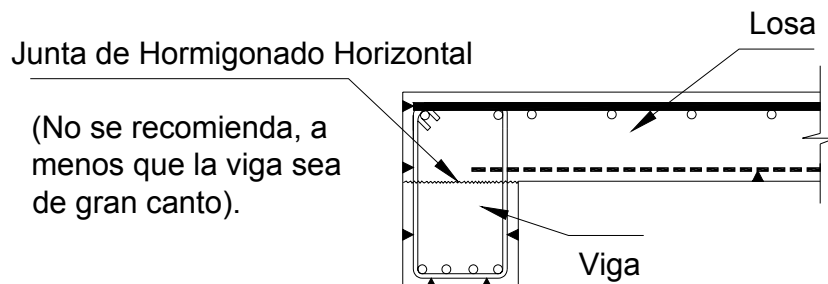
Junta de hormigonado Horizontal entre una losa y una viga.
